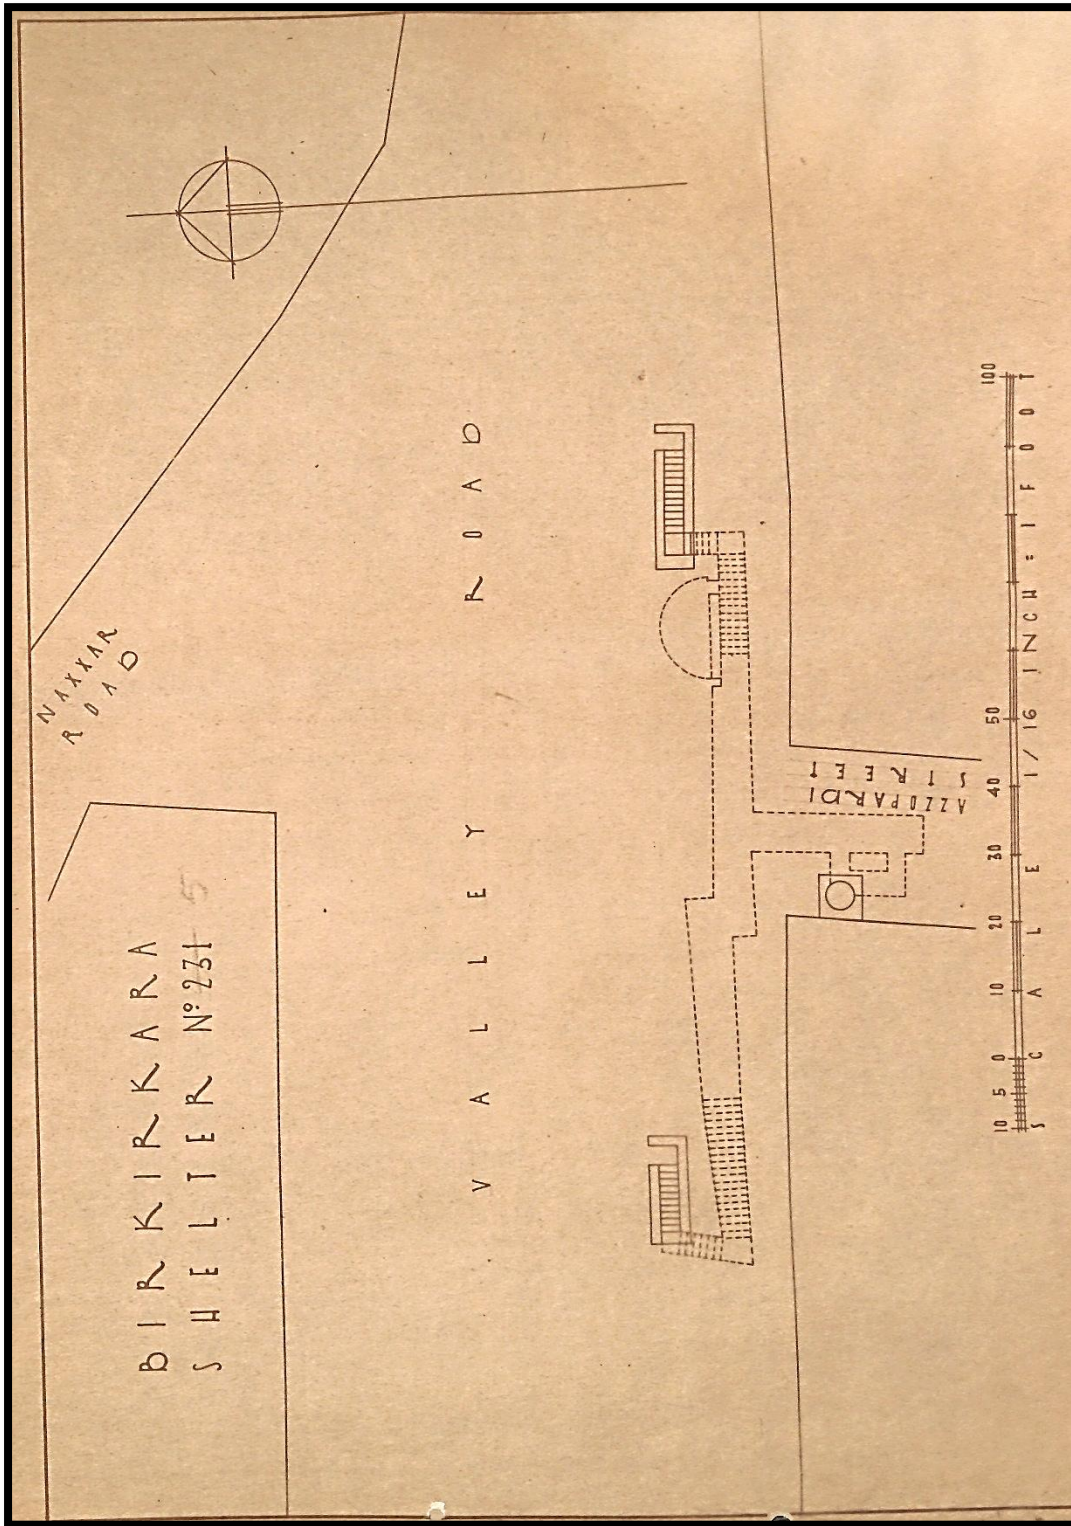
Planta do Abrigo nº321 (5) "Valley Road – Naxxar Road"
